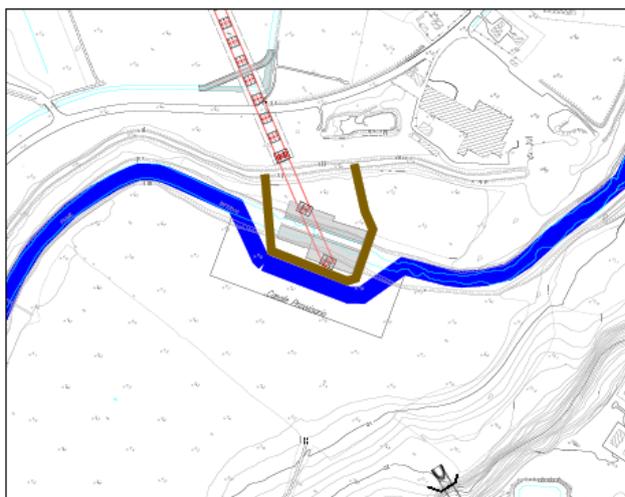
Area modellata, sezione di applicazione dell'onda di piena in ingresso.
